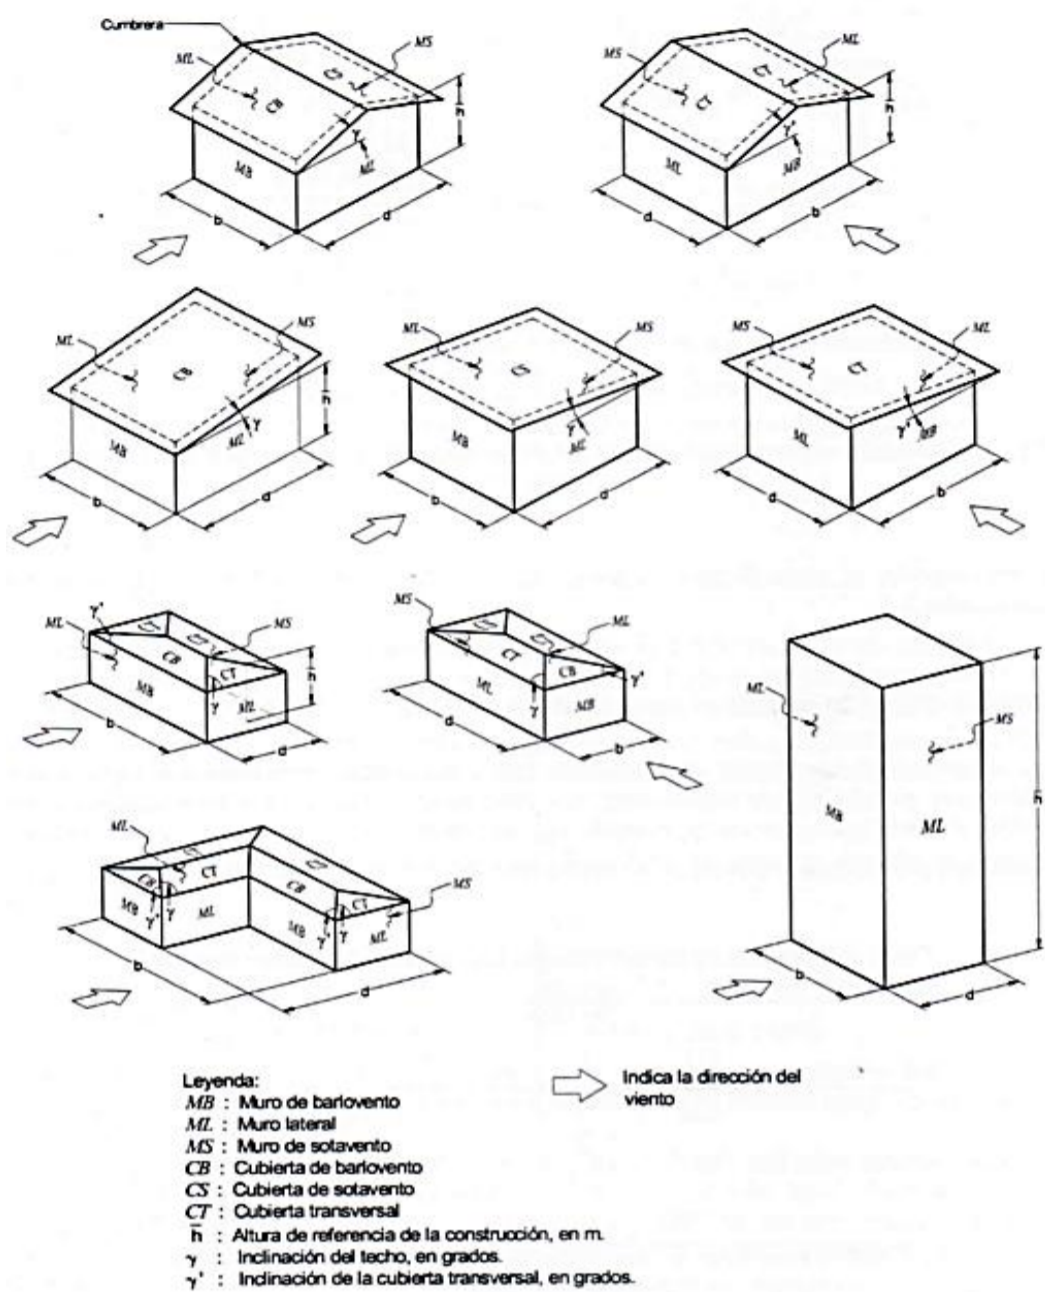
Definición de parámetros de construcción con planta cerrada.
